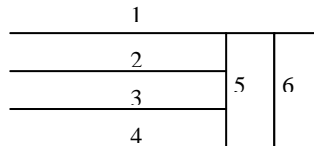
Схема разбивки на захватки по укладке фундаментов под колонны
